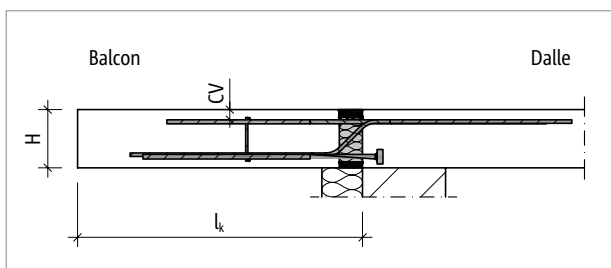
Schöck Isokorb® T type K-T-M13 : système statique
